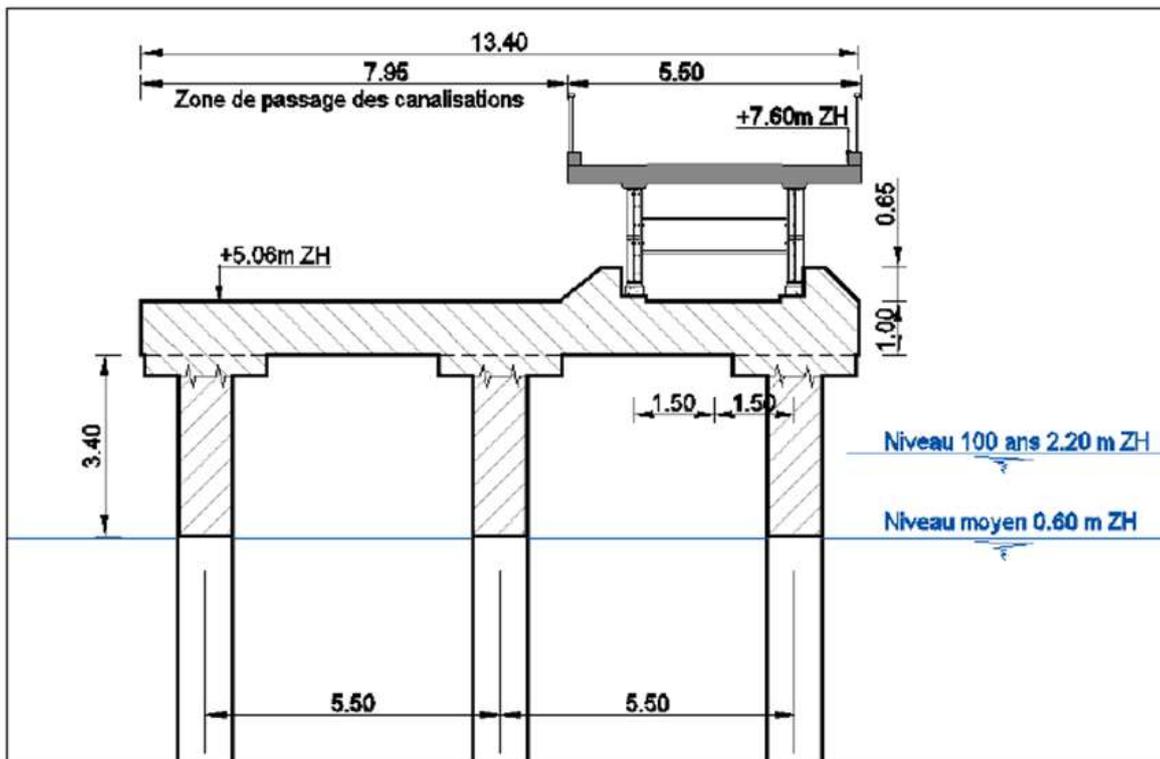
Coupe type de la jetée d'accès avec la voie de service et la réservation pour le pipe-rack
